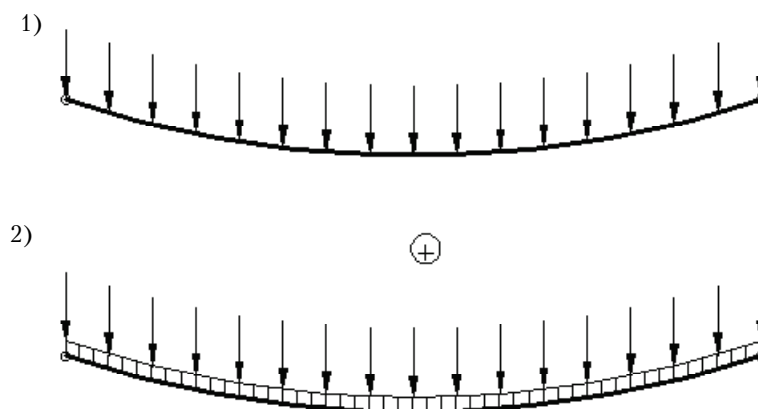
Схема приложения бетонного пригруза как нагрузки: 1 – нагрузка от бетона; 2 – совместная работа мембранного покрытия на нагрузки с бетонным пригрузом.
